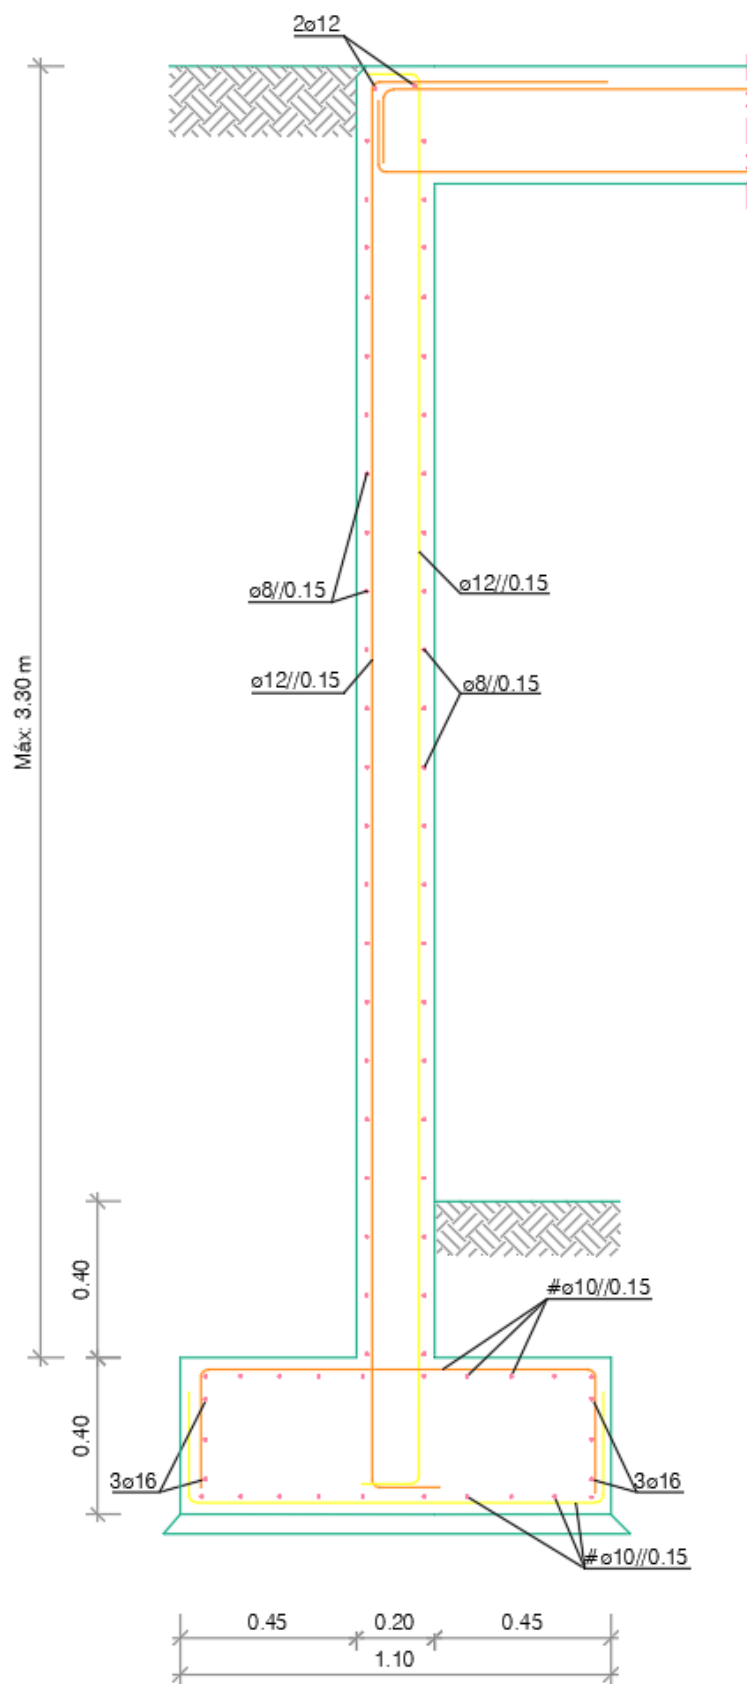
Pormenor Muro Cave (Projeto de estruturas).
